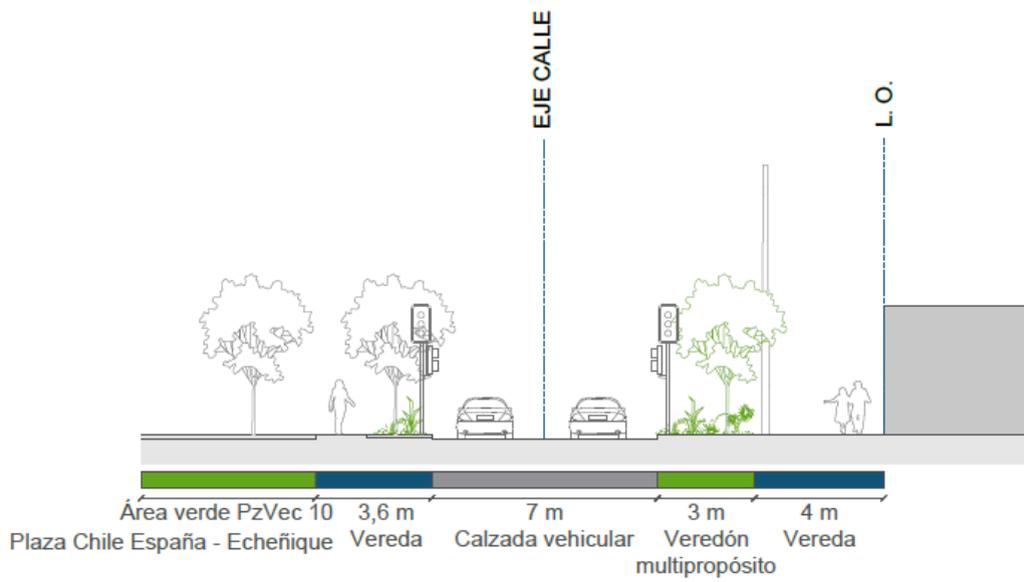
Perfil E-E'. Situación propuesta plaza Chile España - Echeñique.
